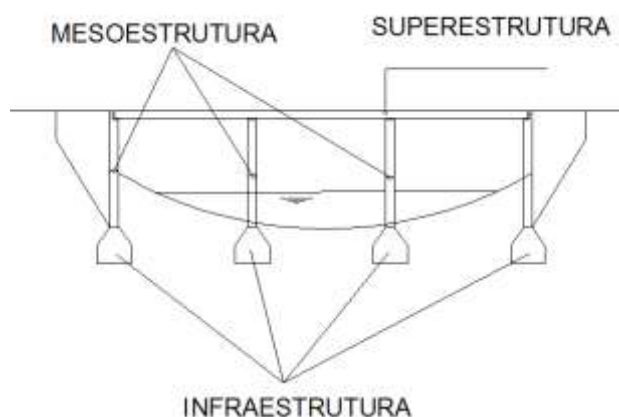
Identificação da superestrutura, mesoestrutura e infraestrutura.
